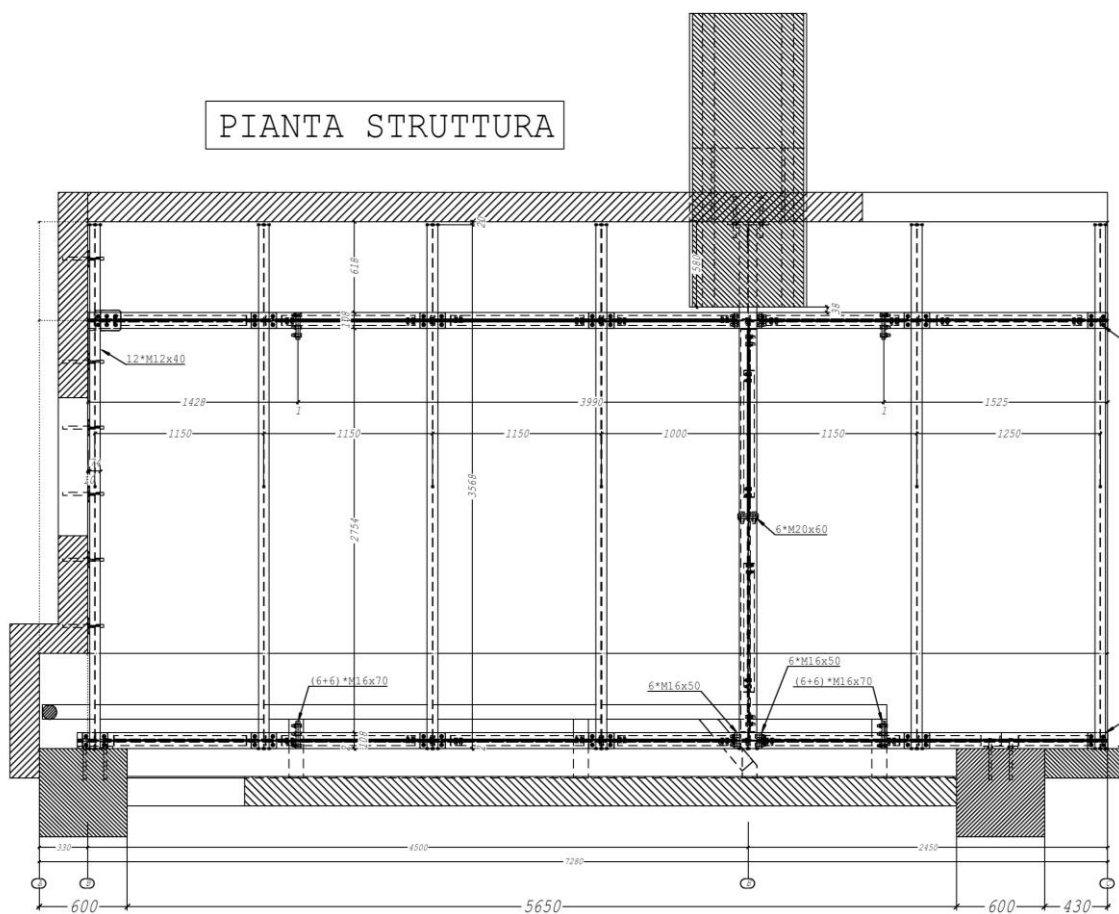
Particolare di A.2010.a.sa.T01 - Progetto della struttura metallica - Pianta
